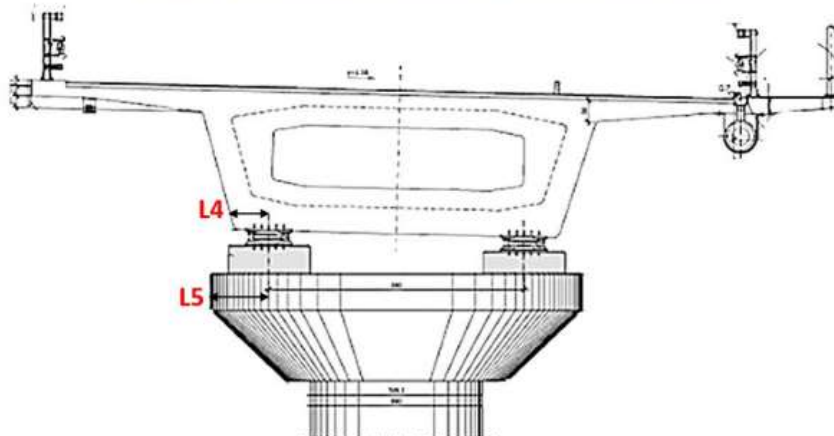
Sistema di appoggio. Distanze da rilevare in direzione trasversale
